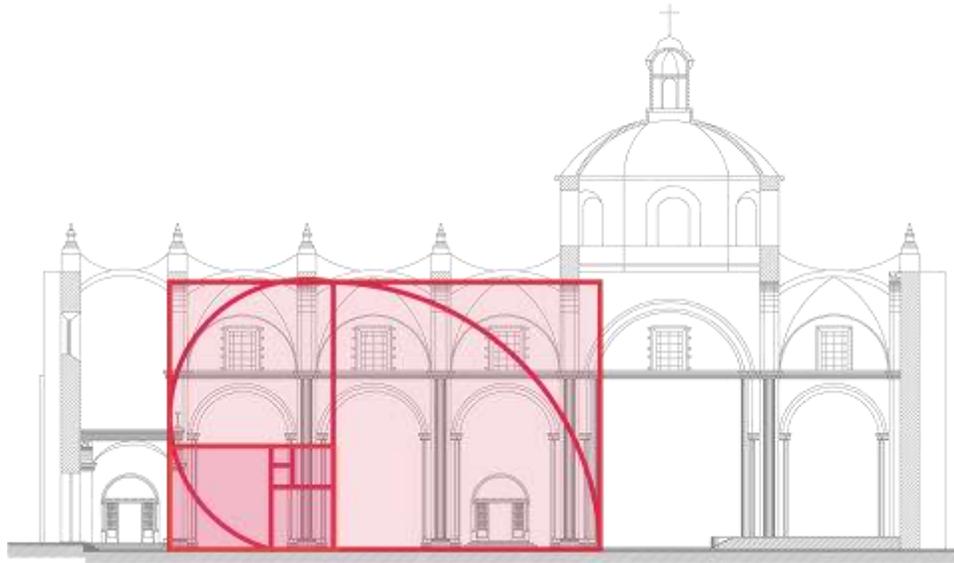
Proporción áurea vista en alzado al interior de la parroquia
